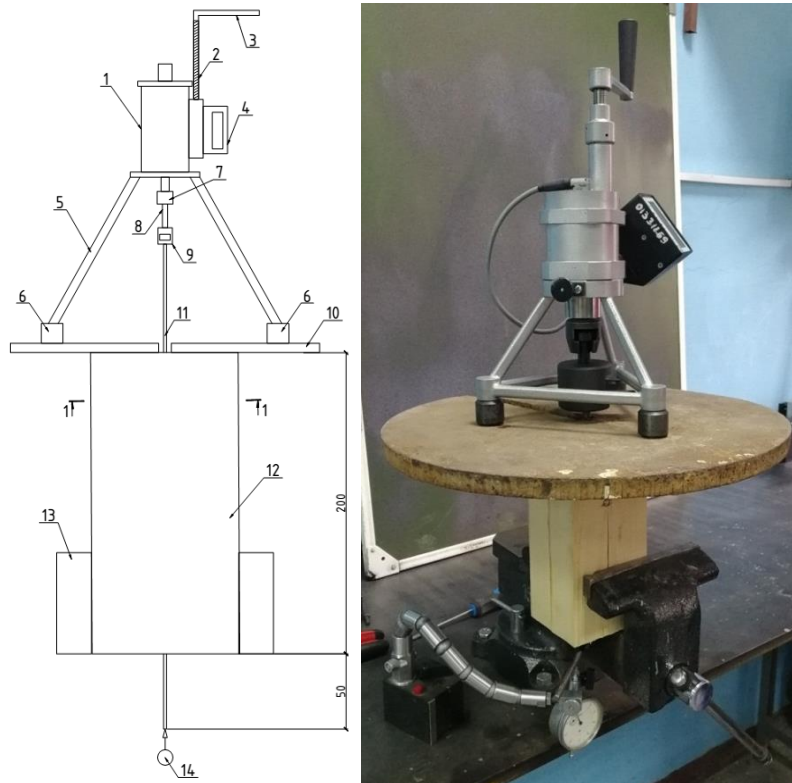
Схема установки испытания образца: 1 – силовозбудитель, 2 – винт силовозбудителя, 3 – винт крепления рукоятки, 4 – электронный блок, 5 – силовая рама, 6 – опора силовой рамы, 7 – вилочный захват, 8 – тяга, 9 – микрометрическая гайка, 10 – пластины для упора силовой рамы, 11 – испытуемый анкер, 12 – деревянный образец, 13 – тиски для фиксирования образца, 14 – индикатор часового типа.
